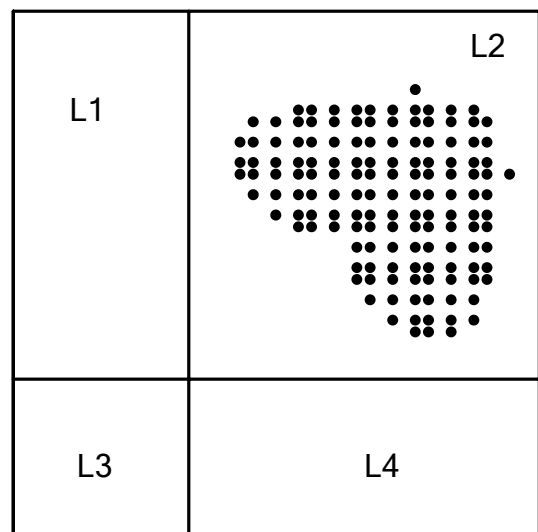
Pontos fissurados na face inferior do pavimento para a carga quase permanente
